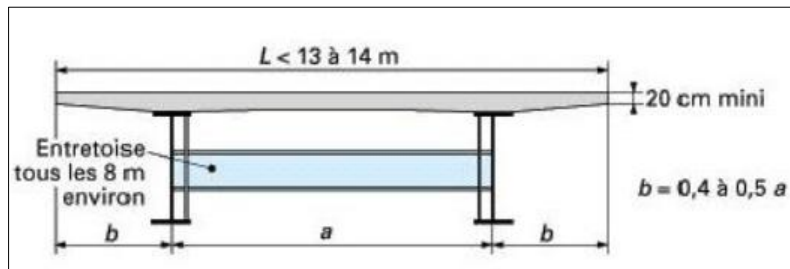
Schéma transversal d'un pont bipoutre à entretoise
